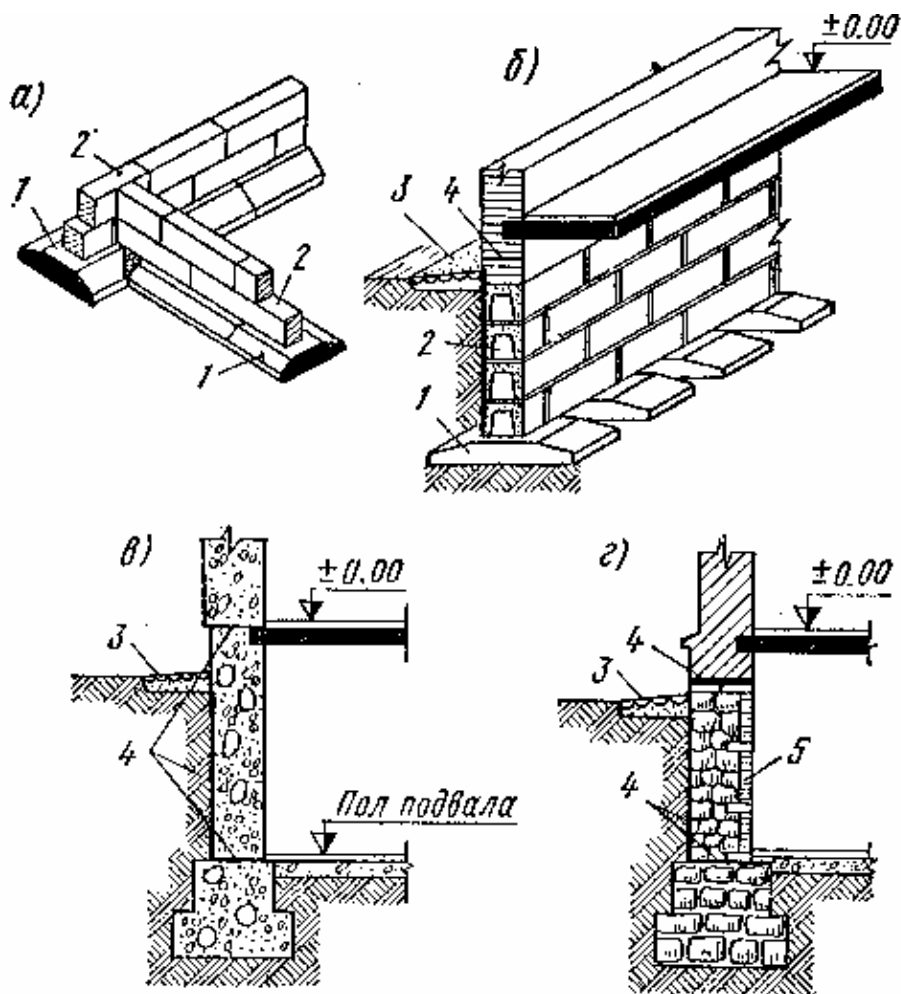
4.7. Конструкции ленточных фундаментов:
